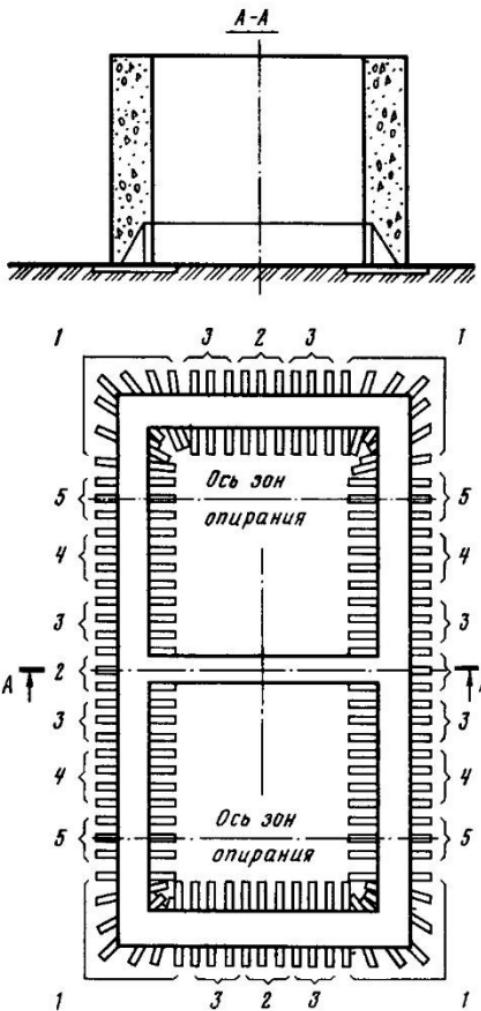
Последовательность удаления подкладок из-под прямоугольного колодца
